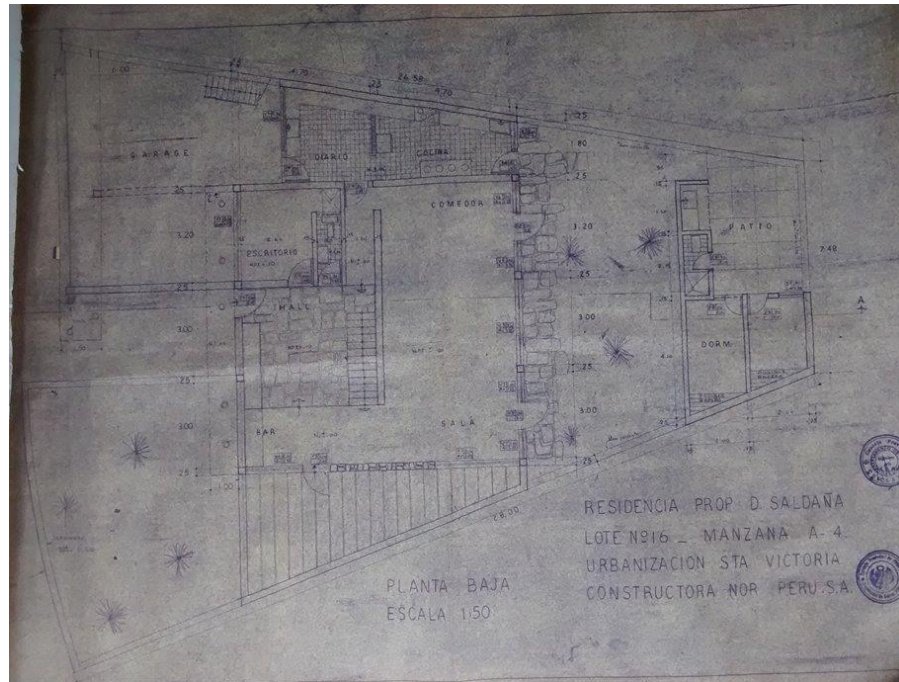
Plano primer nivel. Fuente: Propia.
